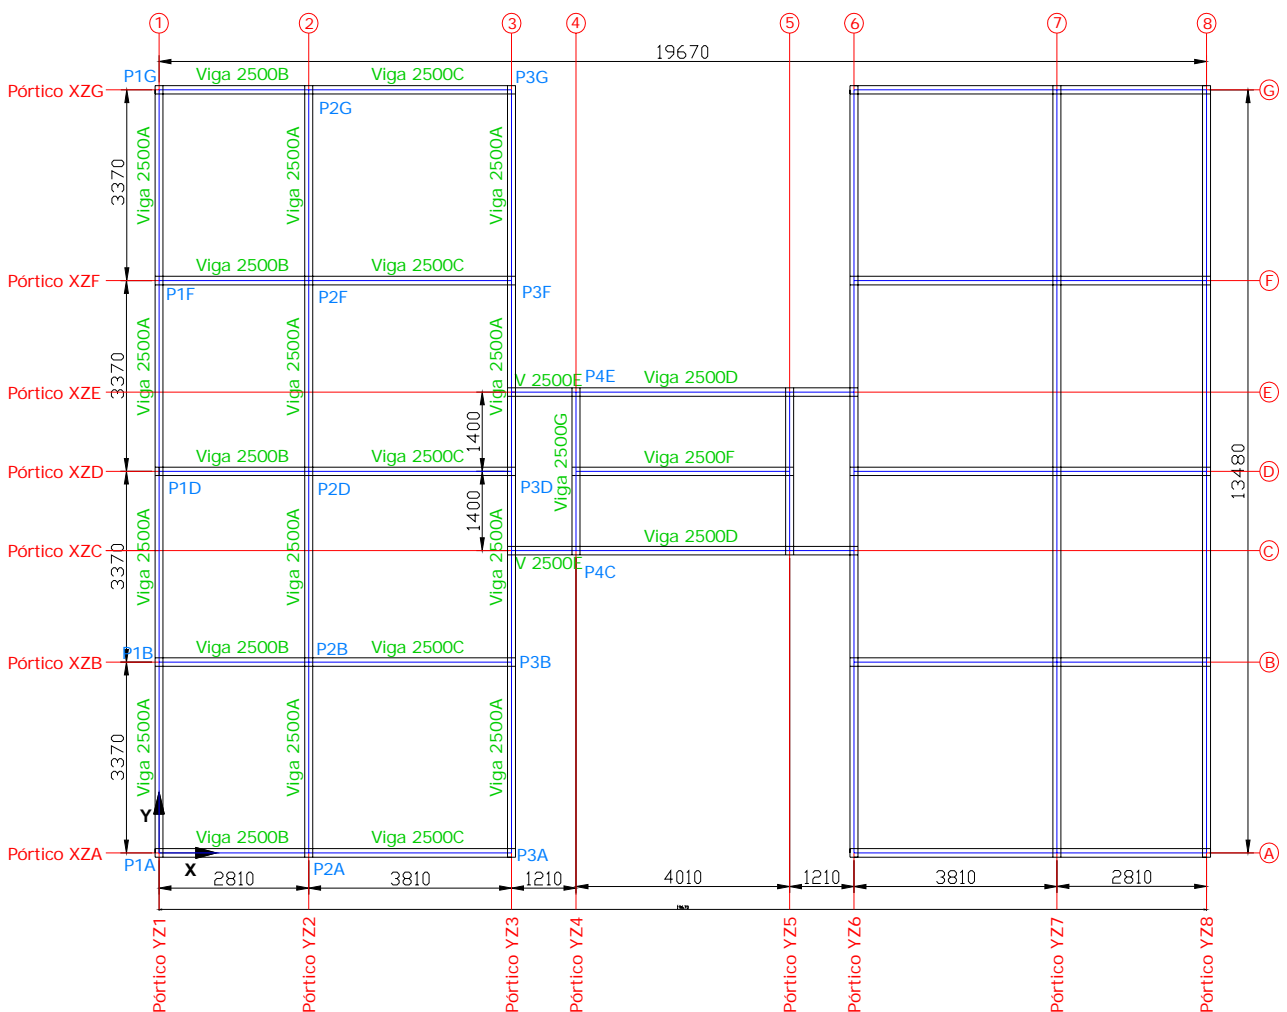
Planta do edifício e nomeação dos elementos estruturais
